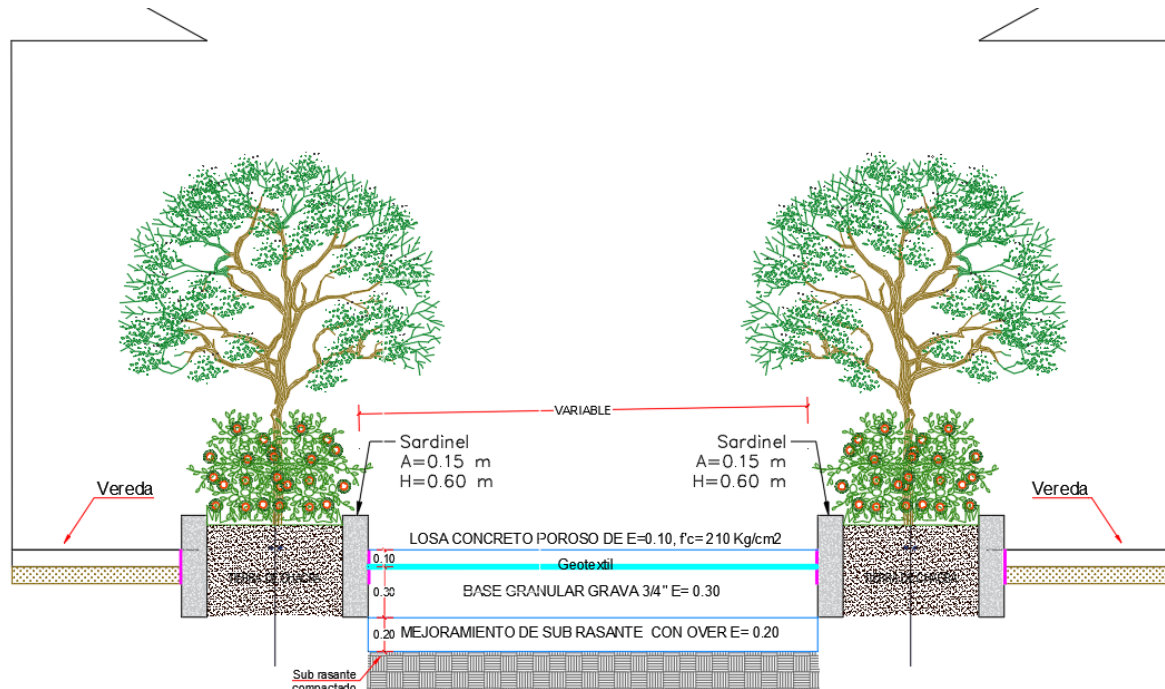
Sección transversal de pavimento permeable propuesta para el pasaje Teofilo Idrogo
